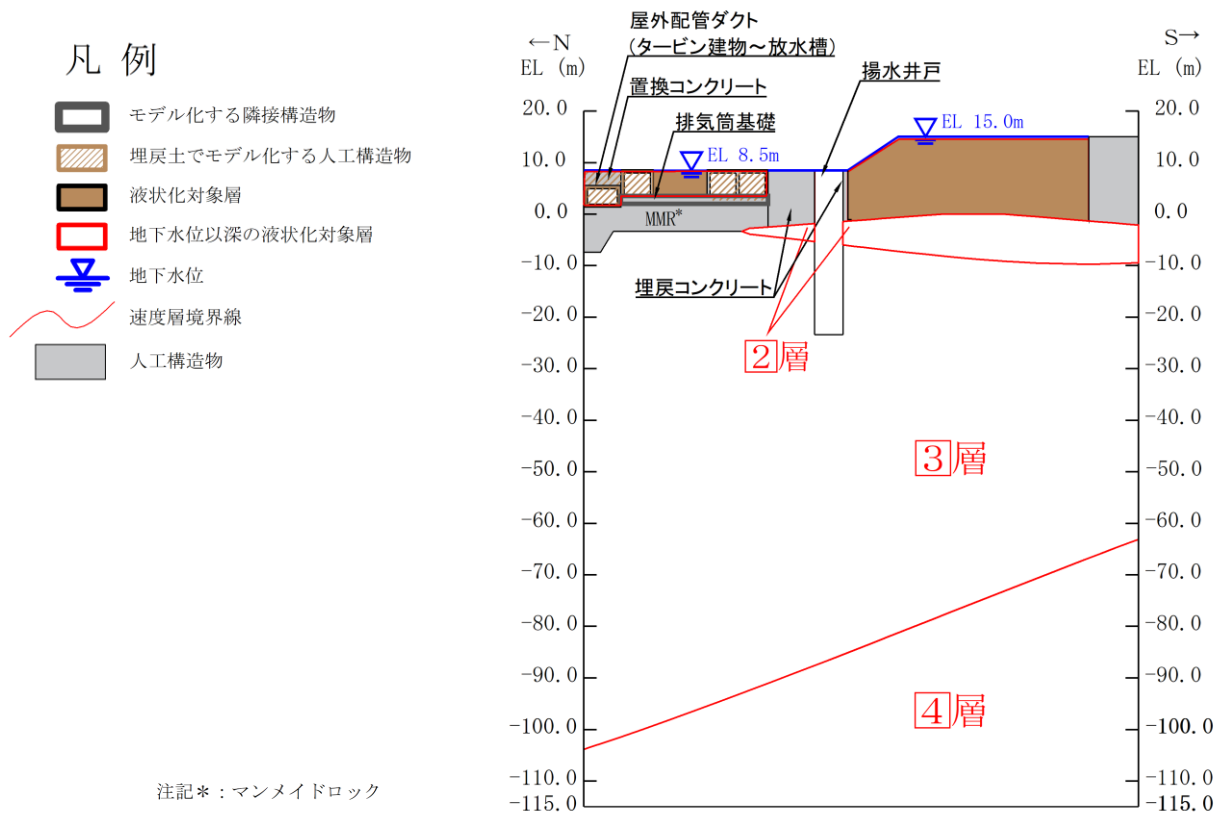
評価対象断面図 (B-B 断面 (南北方向))
